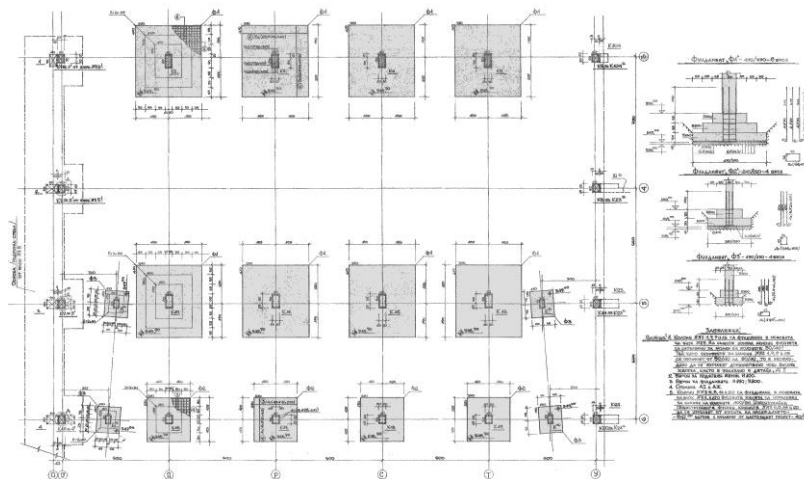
Армировъчен план на рамка – блок 3 на УАСГ
